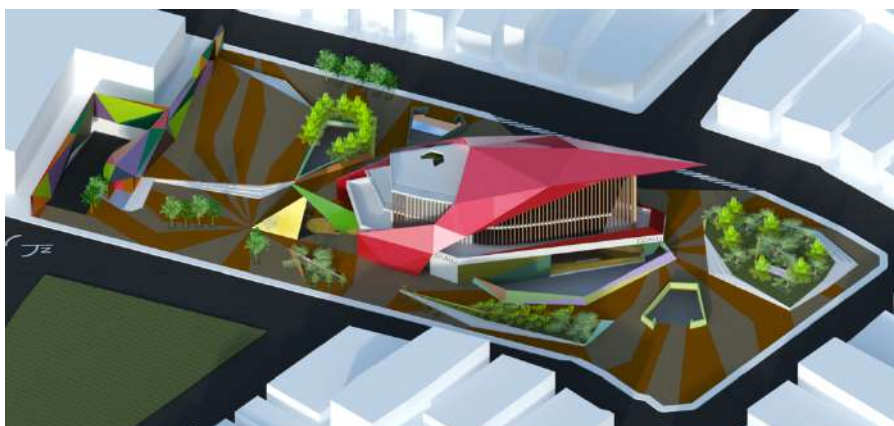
VOLUMEN FINAL CON PIEL - CCAUJ
